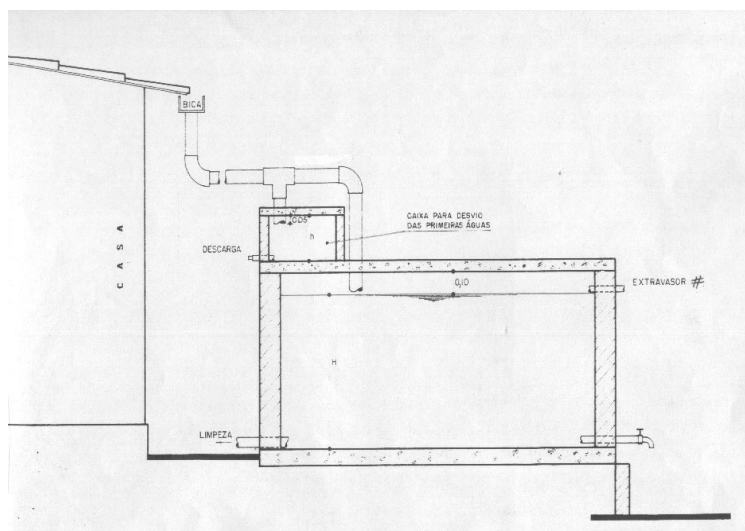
Dispositivo de desvio proposto por Andrade Neto (2004)
